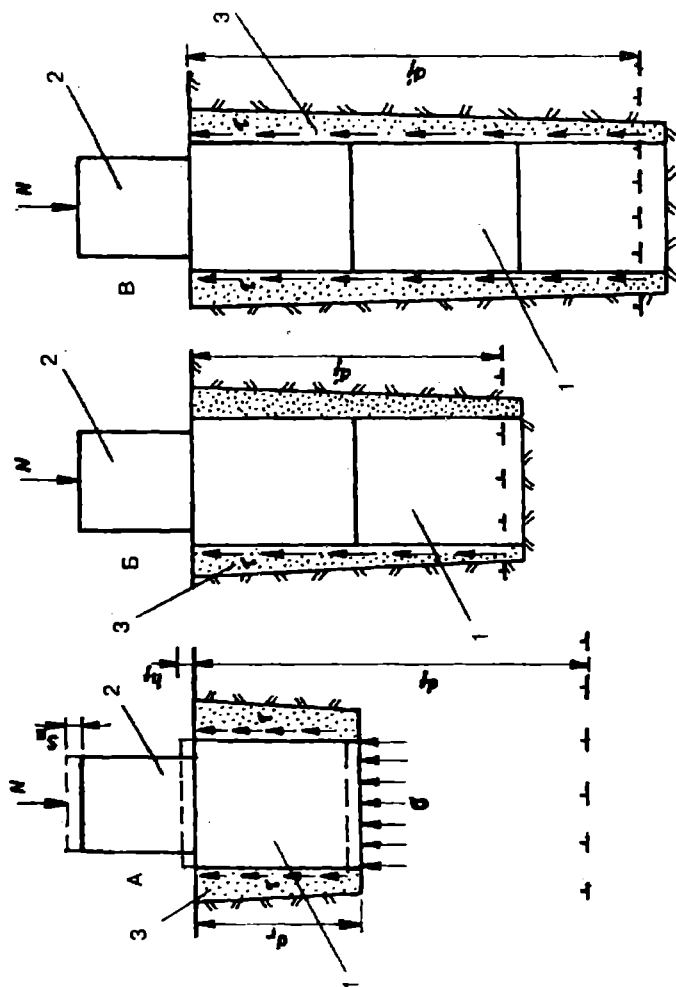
Воздействие на фундамент сил пучения: А — подошва фундамента находится в пределах глубины промерзания; Б — при размещении подошвы фундамента регулярно отапливаемого дома ниже глубины промерзания; В — при размещении подошвы фундамента неотапливаемого дома ниже глубины промерзания; 1 — фундамент; 2 — цоколь; 3 — обратная засыпка;  $\sigma$  — нормальные силы пучения;  $\tau$  — касательные силы пучения;  $N$  — нагрузка от дома;  $d_f$  — глубина промерзания;  $d_f''$  — глубина промерзания отапливаемого дома;  $d_f'''$  — глубина промерзания неотапливаемого дома;  $d_T$  — глубина траншеи;  $h_f$  — деформация пучения грунта;  $S_u$  — величина перемещения фундамента
